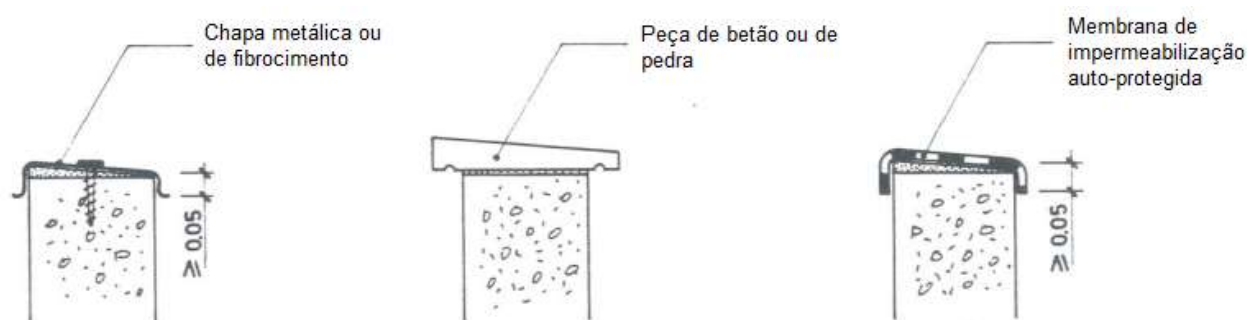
Pormenores construtivos de capeamentos de platibandas (adaptado de Lopes, 1994b)
